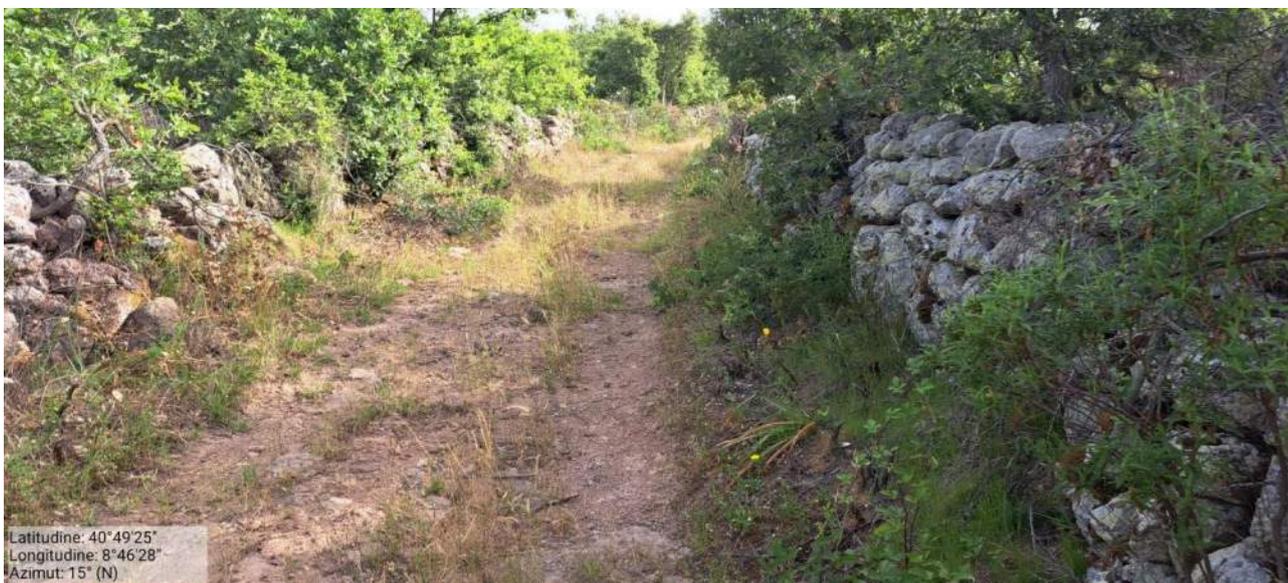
Tratturo campestre attraversato dalla viabilità in adeguamento di accesso alla postazione eolica T07 (direzione nord).
